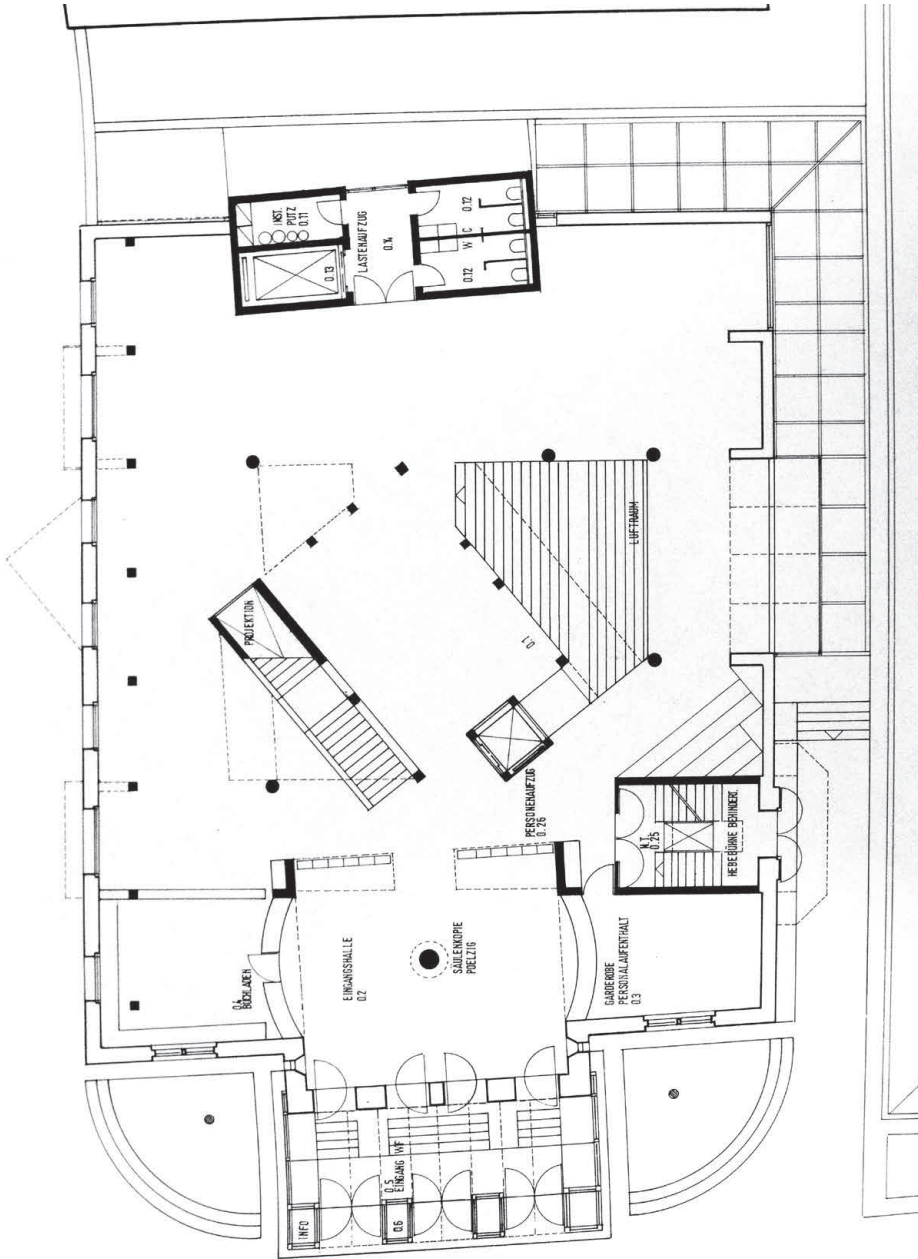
Deutsches Filmmuseum, Grundriss, Erdgeschoss
